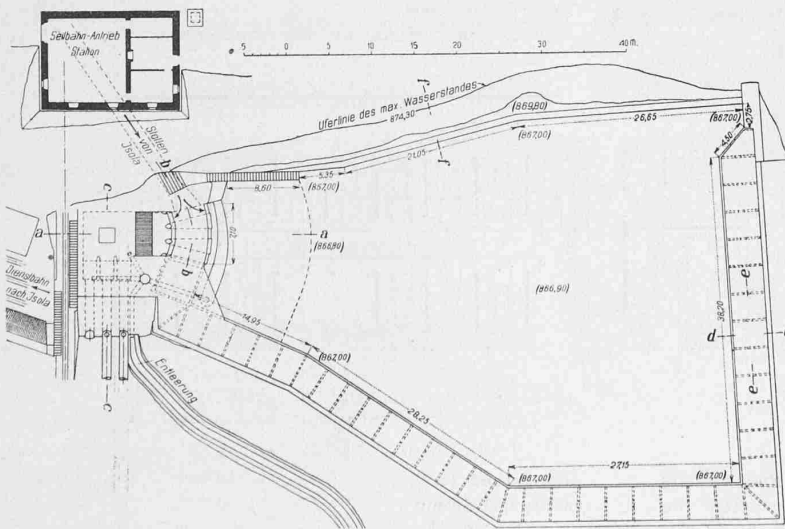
Lageplan von Wasserschloss und Ausgleichbecken Cedegolo. — 1 : 800.
